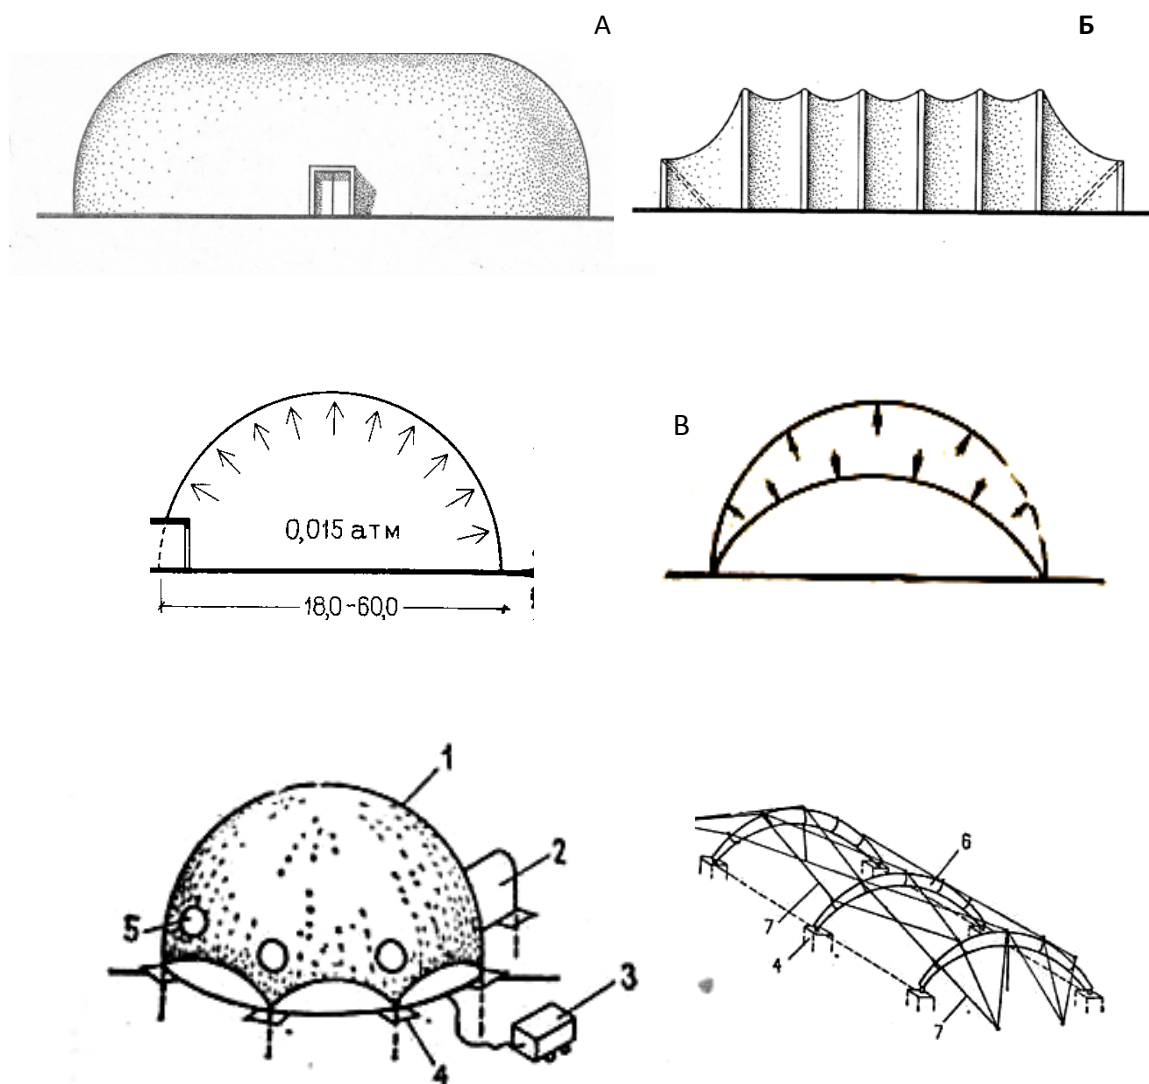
Пневматические конструкции. А. Воздухоопорные, Б. пневмокаркасные. Конструкции: 1 – воздухоопорная оболочка, 2 – шлюз, 3 – компрессор, 4 – анкер для крепления к земле, 5 – окно - иллюминатор, 6 – пневматическая арка, 7 – продольные связи-растяжки.
